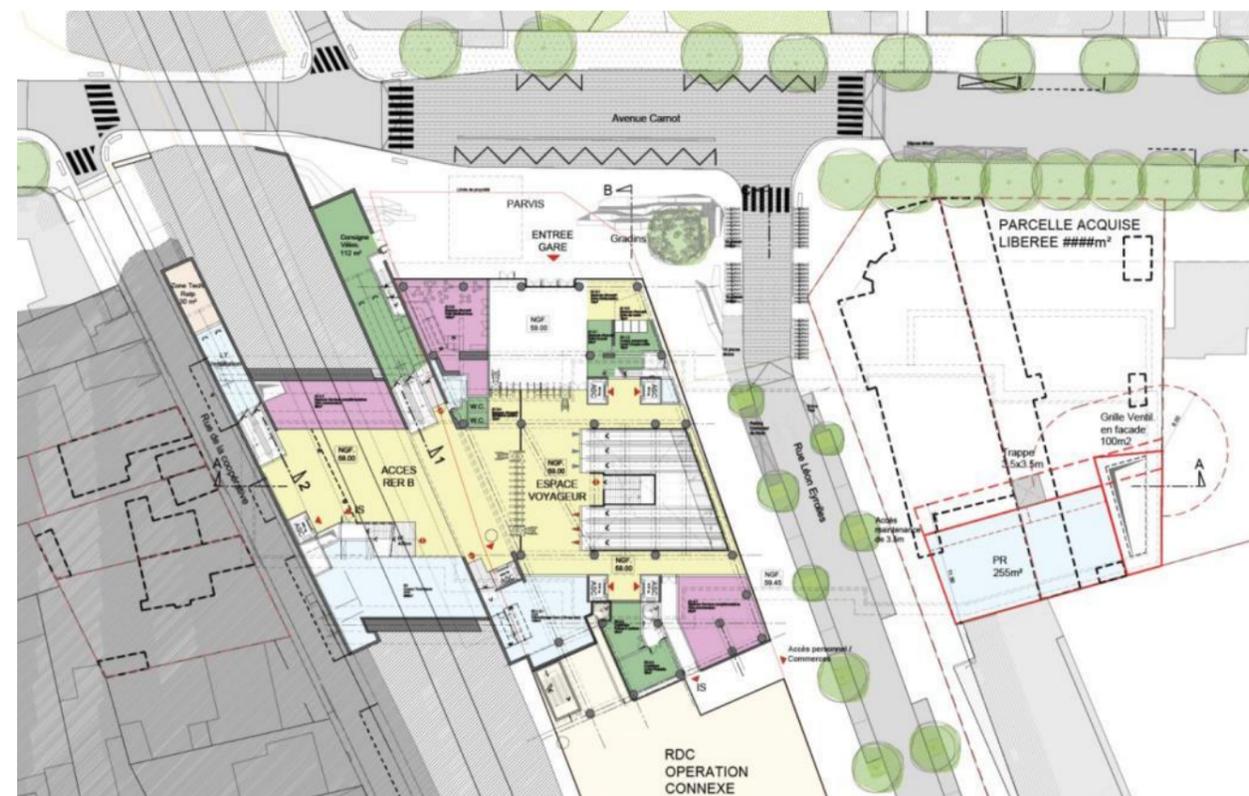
Gare d'Arcueil Cachan – Plan de RDC
